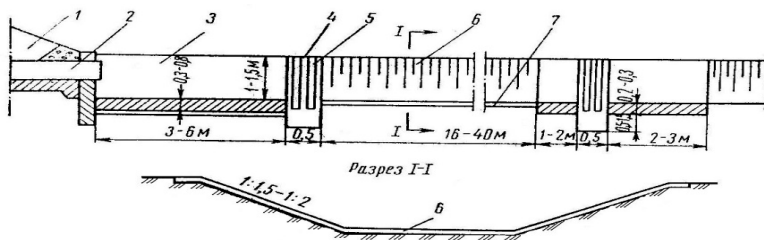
Железобетонный рыбоуловитель для нагульных и выростных прудов:
